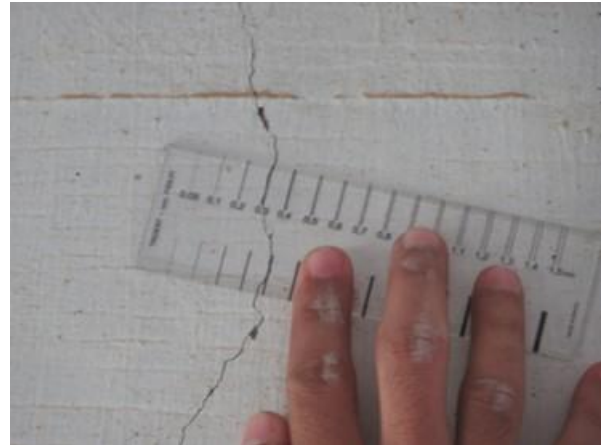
Viga transversina 4– Abertura de fissura igual a 0,3 mm..
